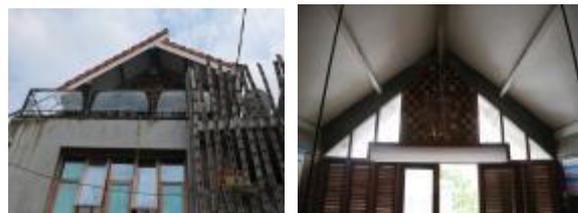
Penerapan material plafond kayu (Survey Lapangan, 2019)
